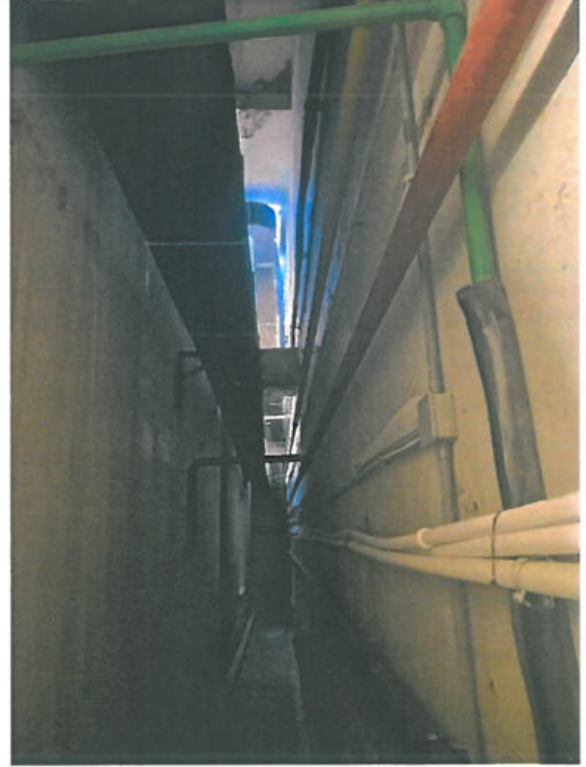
Kiriş ve Kaset döşeme, A blok girişi, binanın kirişler ile çevre perde duvar bağlantısı.
